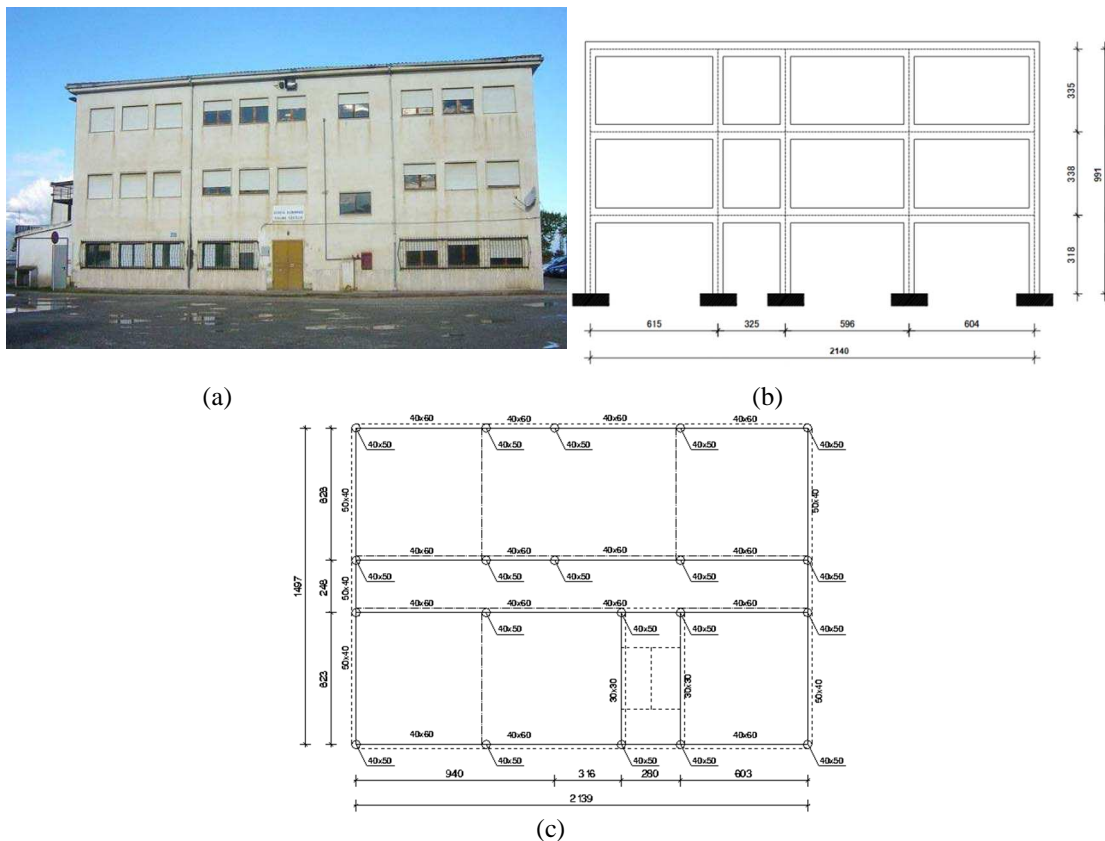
(a) Prospetto. (b) Sezione longitudinale dell'edificio. (c) Pianta del secondo piano.
